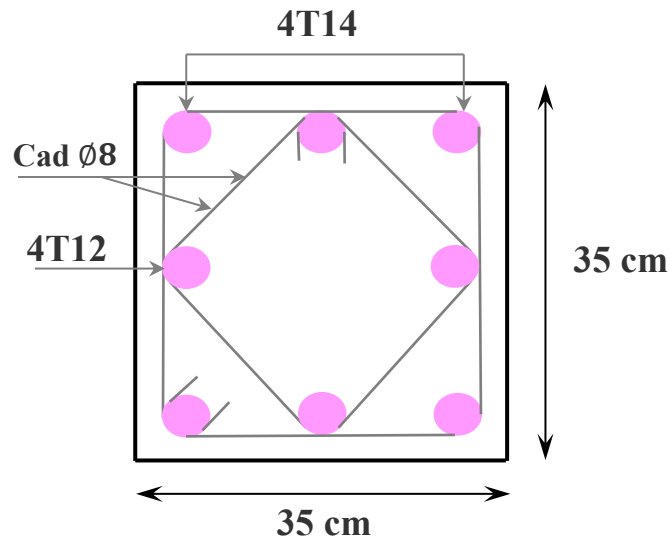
Schéma de ferrailage des poteaux 35×35.
